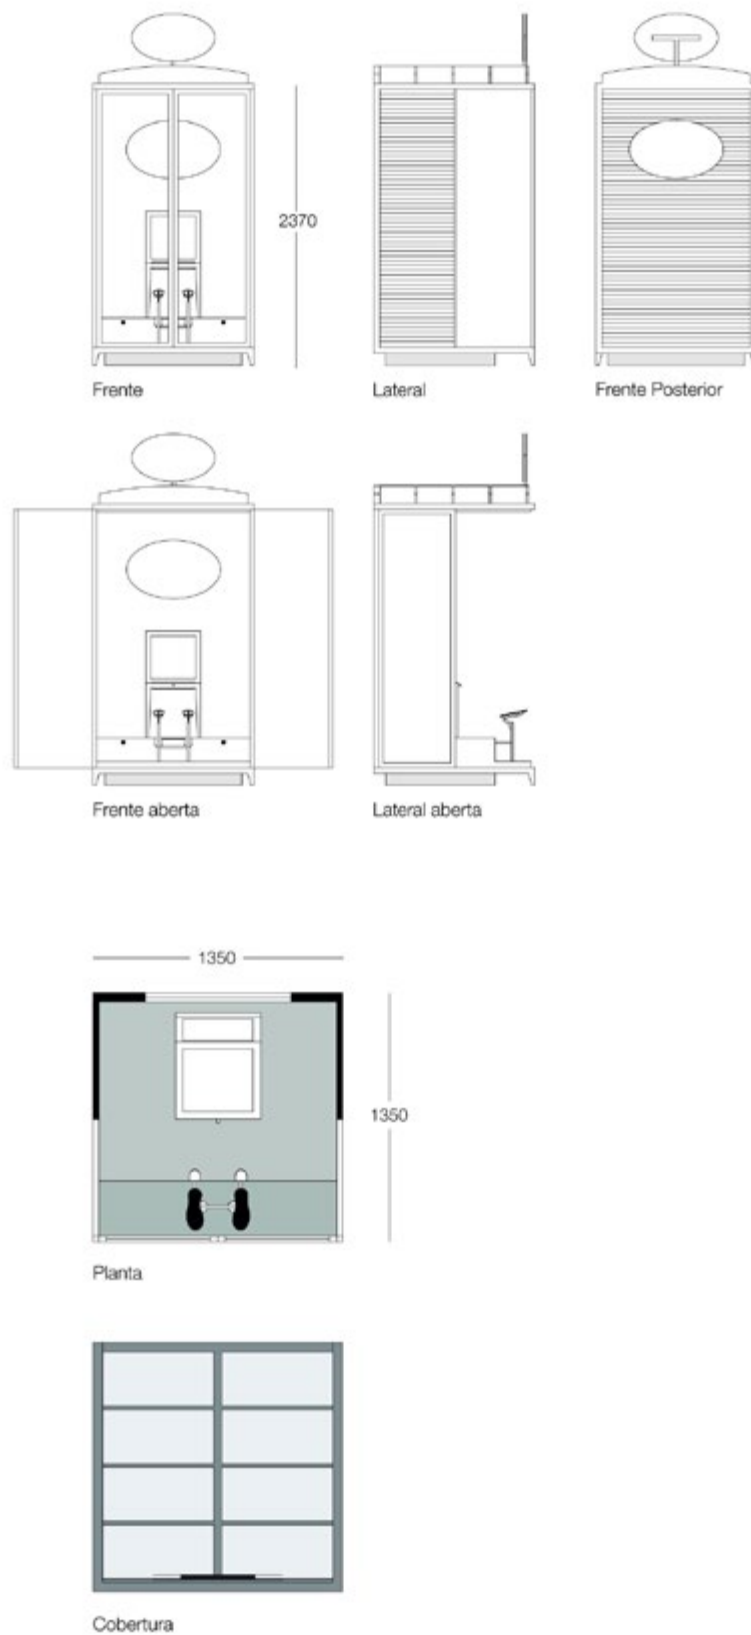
Desenho técnico do Projeto 3 - Banca Engraxadores dos Arcos
